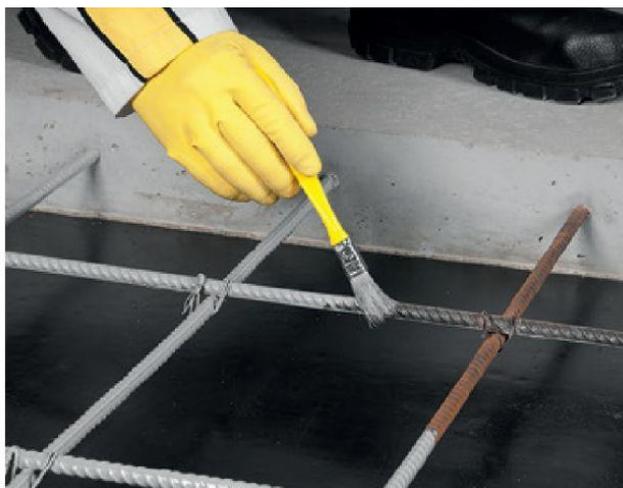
Ilustração - Aplicação de inibidor de ferrugem
